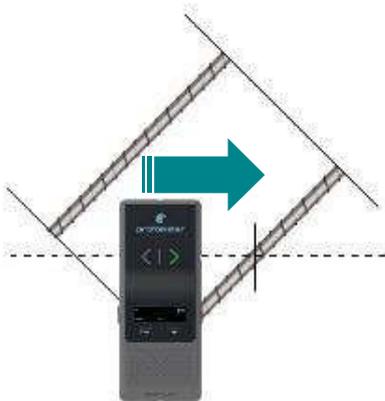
Bewegung im Winkel zu den Bewehrungsstäben
